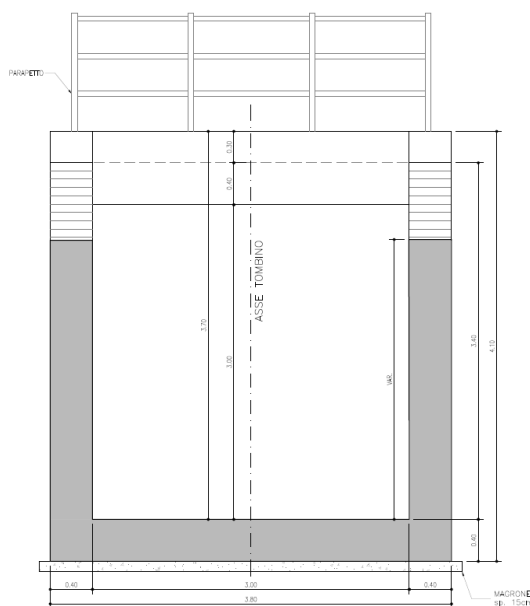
Manufatto di sbocco - Sezione trasversale
